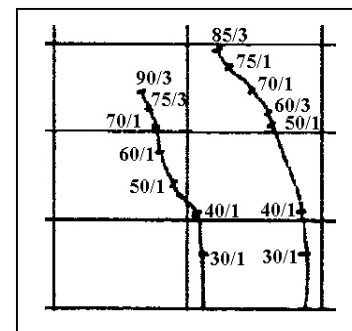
Detailausschnitt aus dem betrachteten Versuchsbalken
